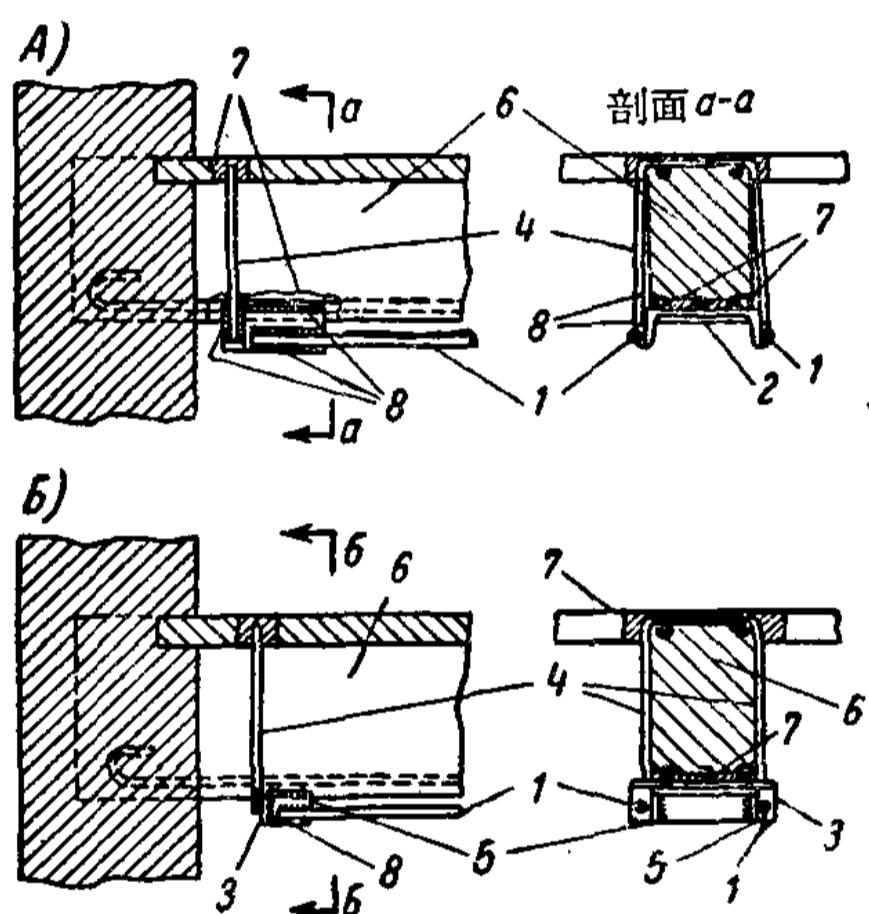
钢筋混凝土构件边支座上水平补强拉杆的锚固装置结构
